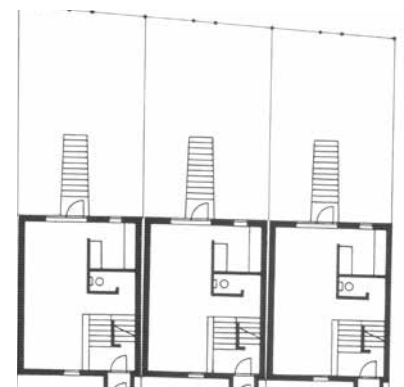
Grundriss Reihenhaus, Pilotengasse Wien
